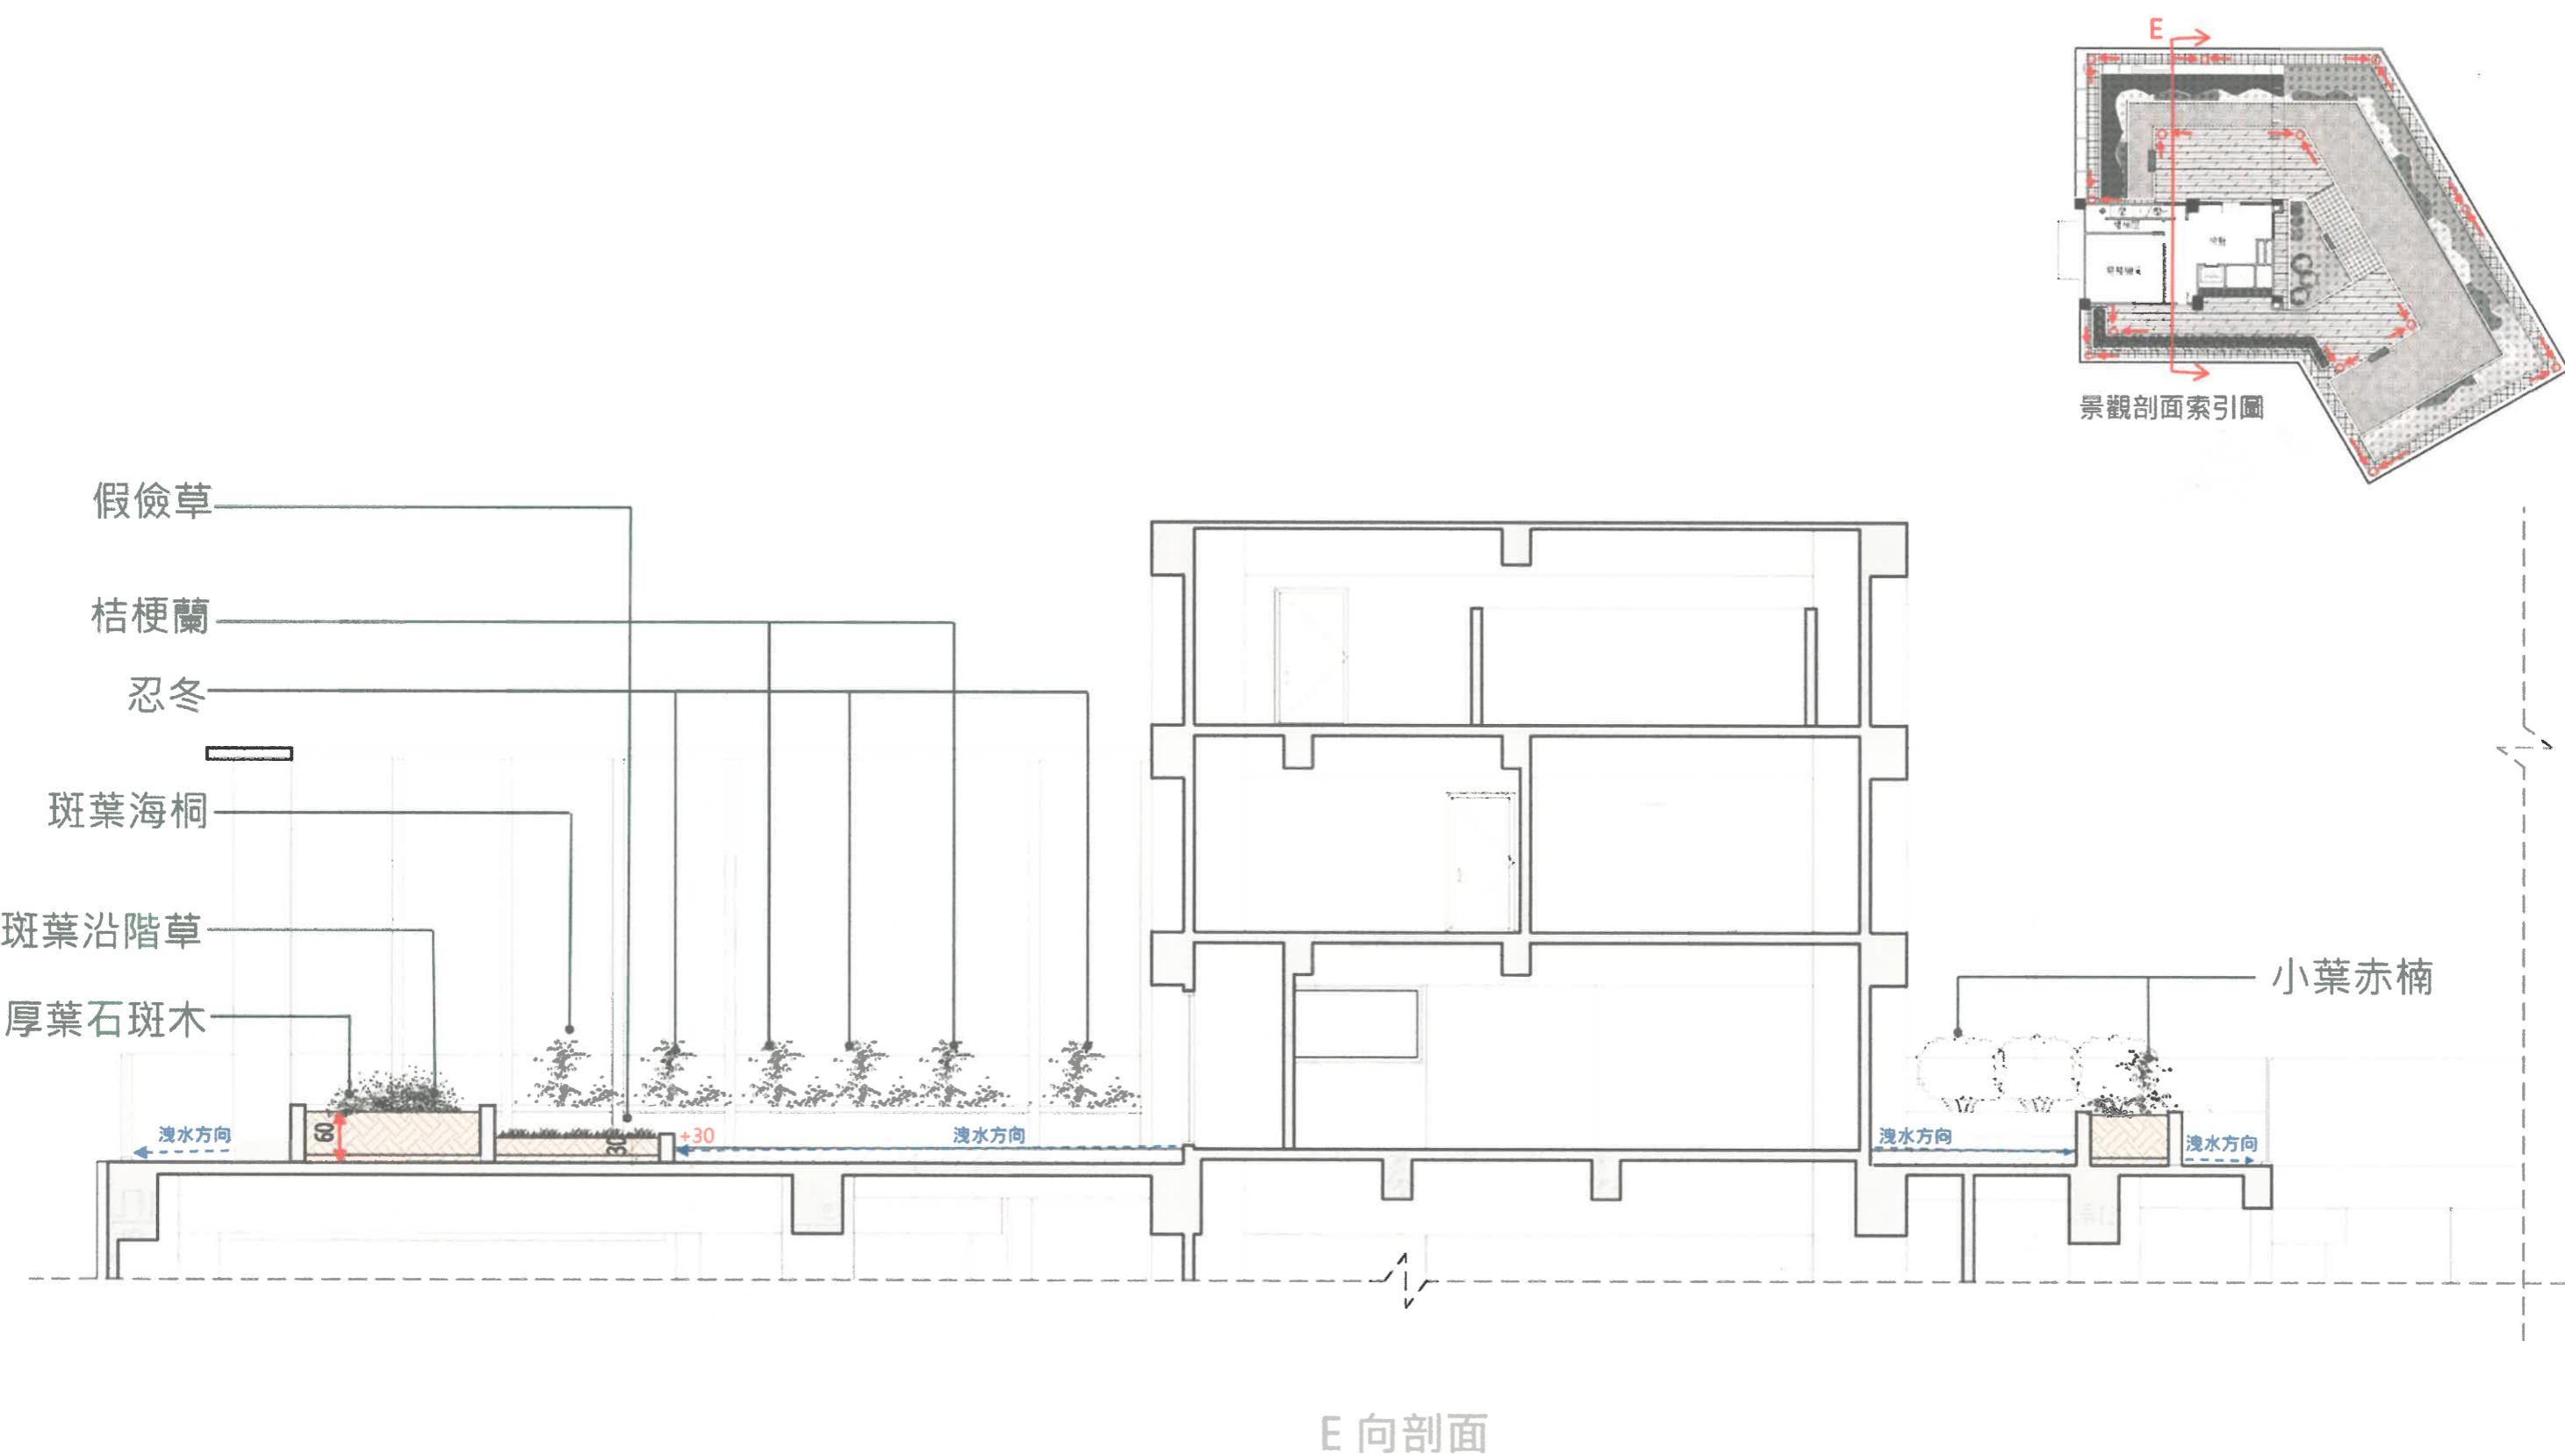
屋頂層景觀剖面示意圖 1(維持原核定)
